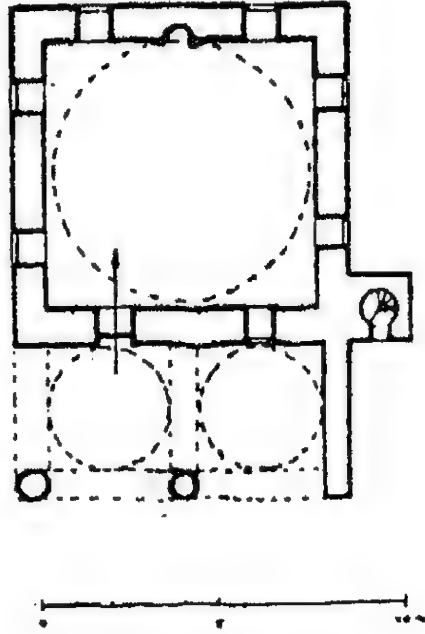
مكرر) مسقط أفقي لمسجد علي باشا في Szigetvár المجرية (عن : جيرو) .
